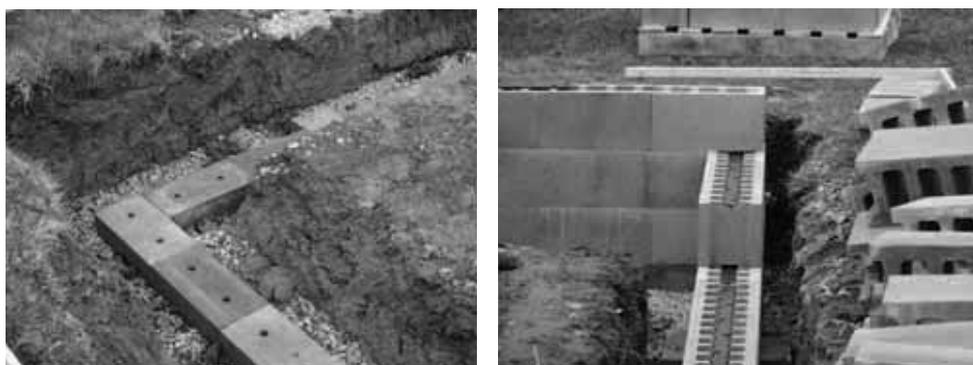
Levantamiento de un muro con el sistema Bolt-A-block. Arranque con piezas macizas sobre un encachado de grava compactada [izquierda]. Hiladas con pletinas interpuestas para el atornillado de las barras roscadas [derecha].
